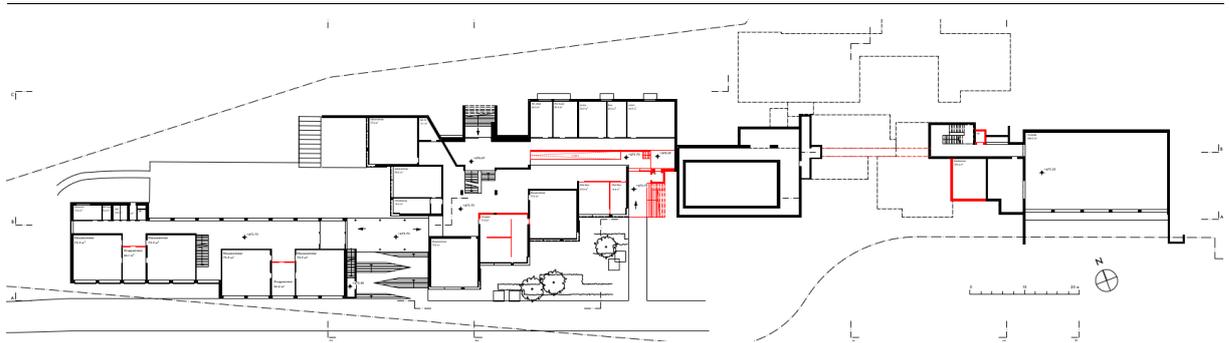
Ebene 0 Grundriss Erdgeschoss
